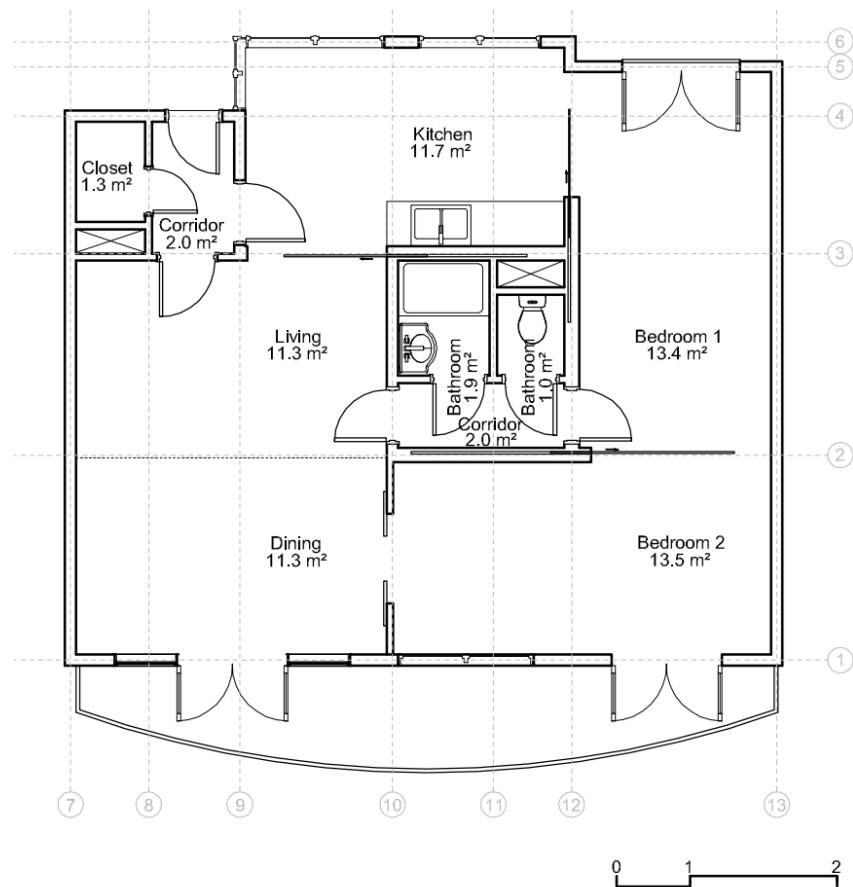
Planta baixa Dapperbuurt no Revit.
